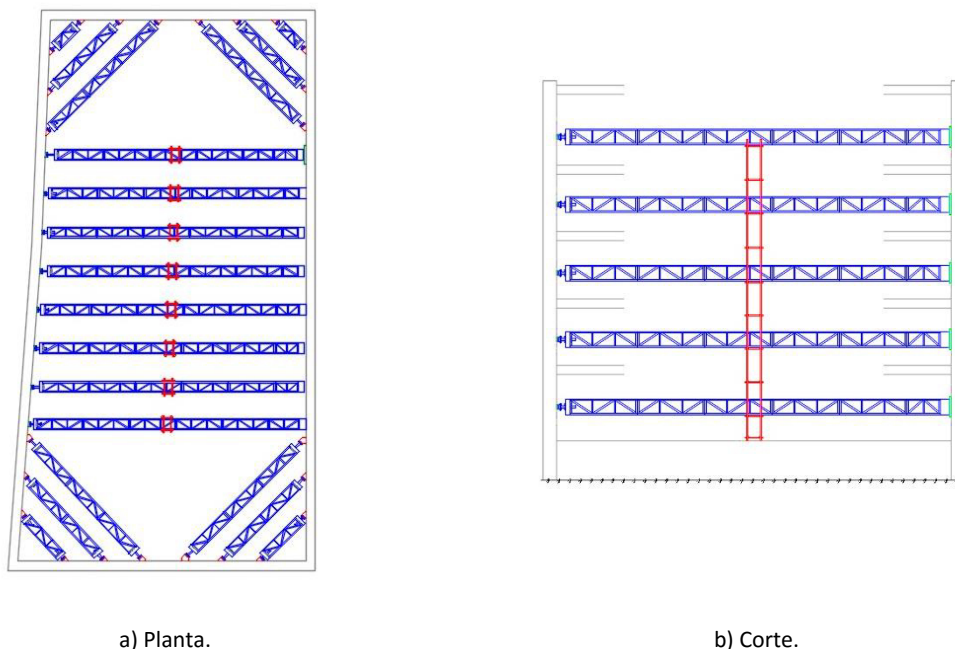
Ilustração tipo da solução de colunas metálicas.
